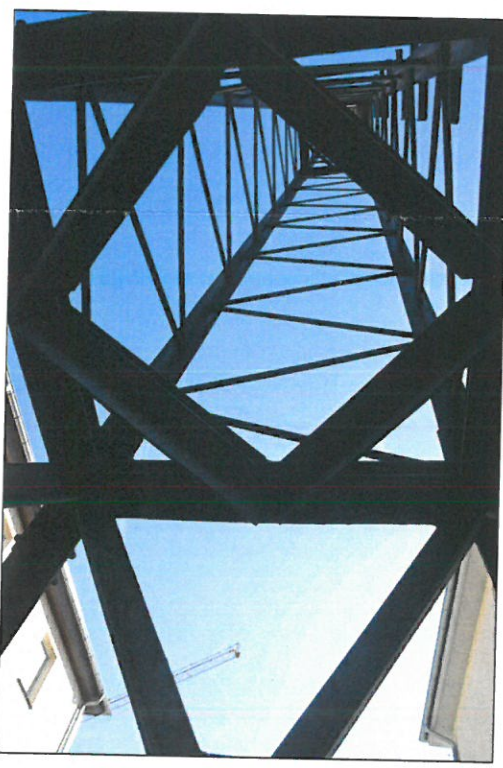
POŁĄCZENIE SEGMENTÓW
